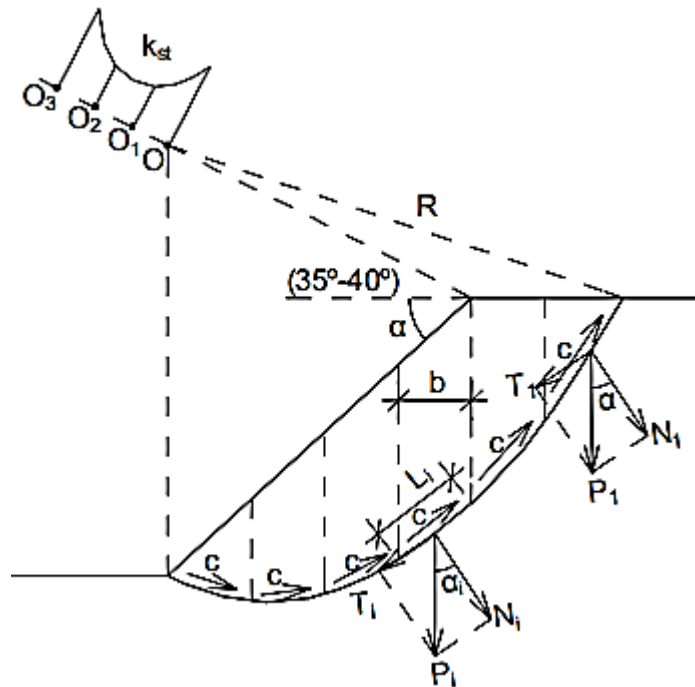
Розрахункова схема при розрахунку за методом круглоциліндричних поверхонь
